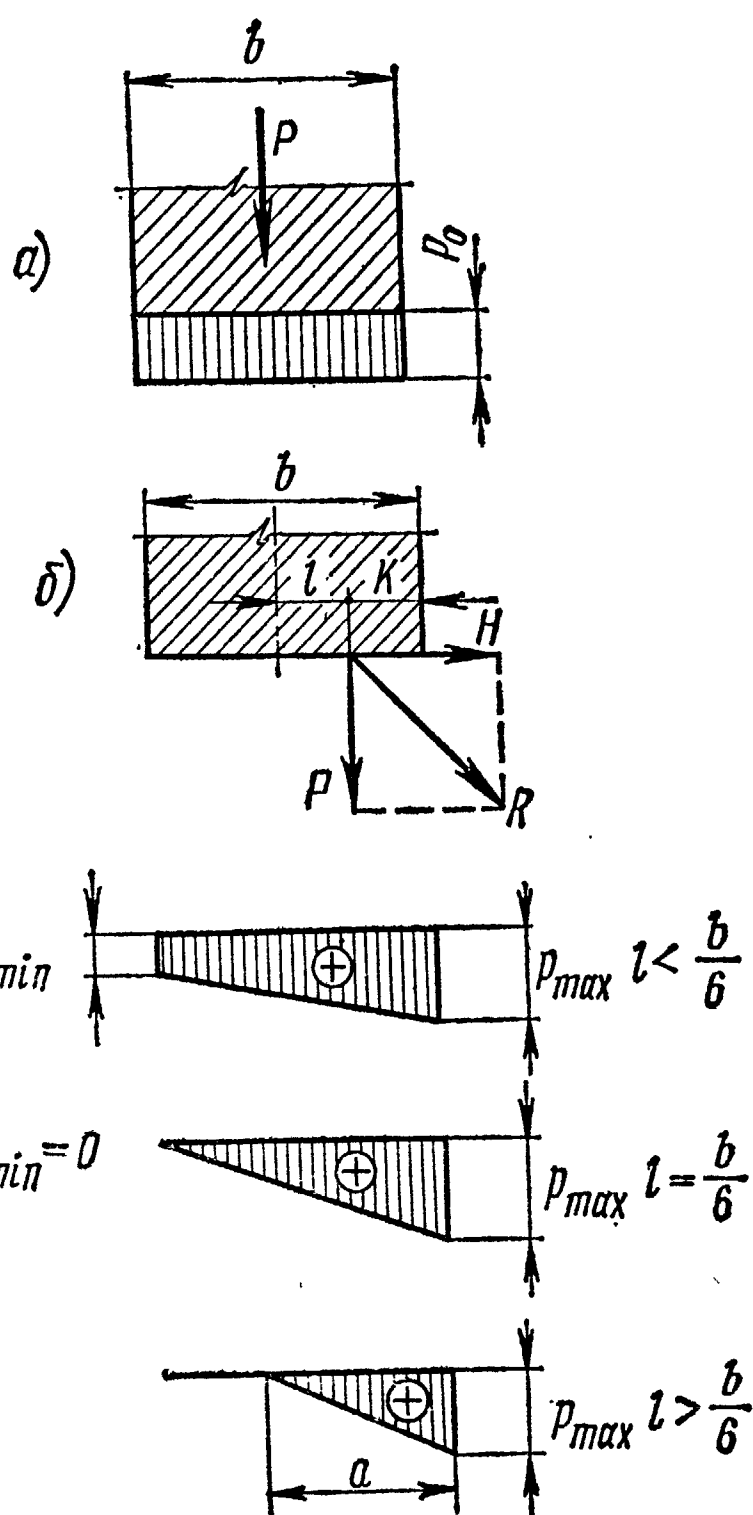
Упрощенная схема напряжений по подошве фундамента:
